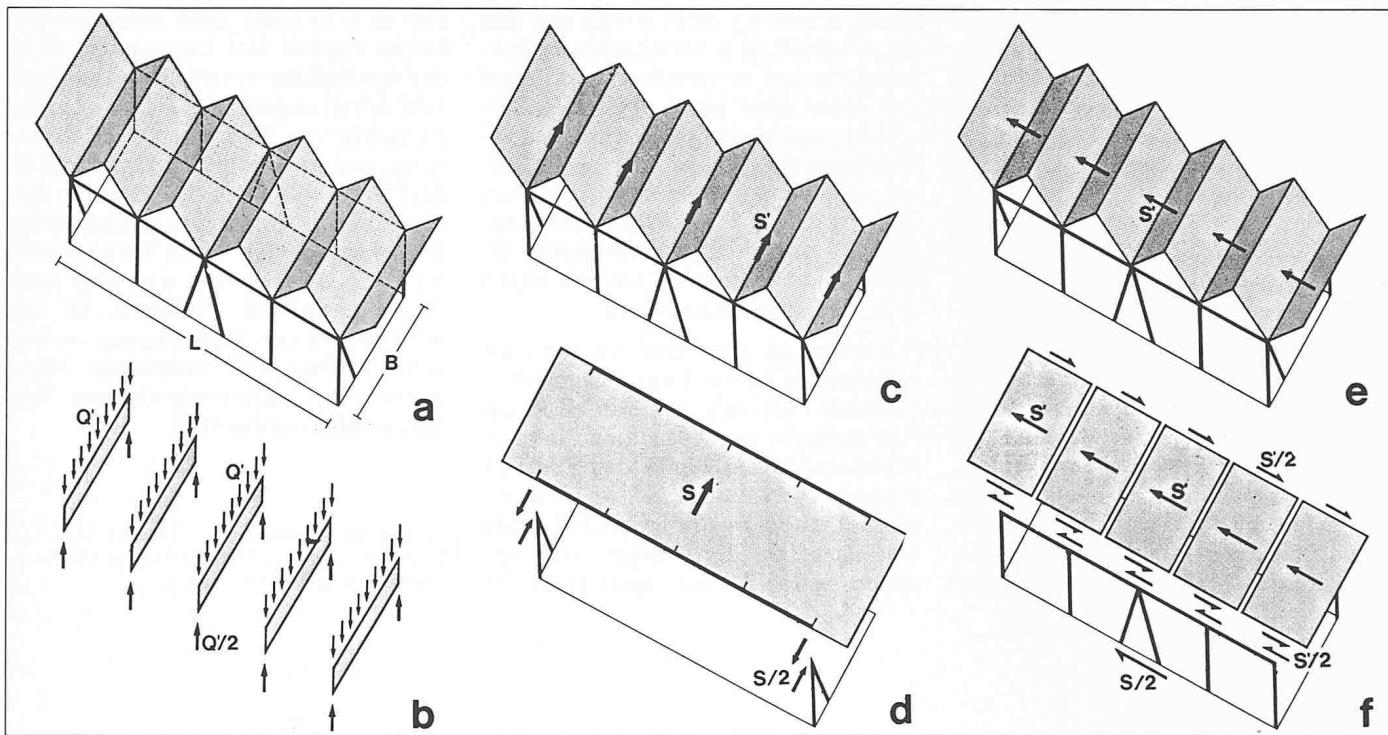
a) Hallenträgerwerk aus einem V-Faltendach und vertikalen Stützen, b) Membranwirkung des Daches in der Hallenquerrichtung bei Vertikallast, c) Tragwerk und Horizontallast in der Hallenquerrichtung, d) entsprechendes Tragverhalten, e) Tragwerk und Horizontallast in der Hallenlängsrichtung, f) entsprechendes Tragverhalten
